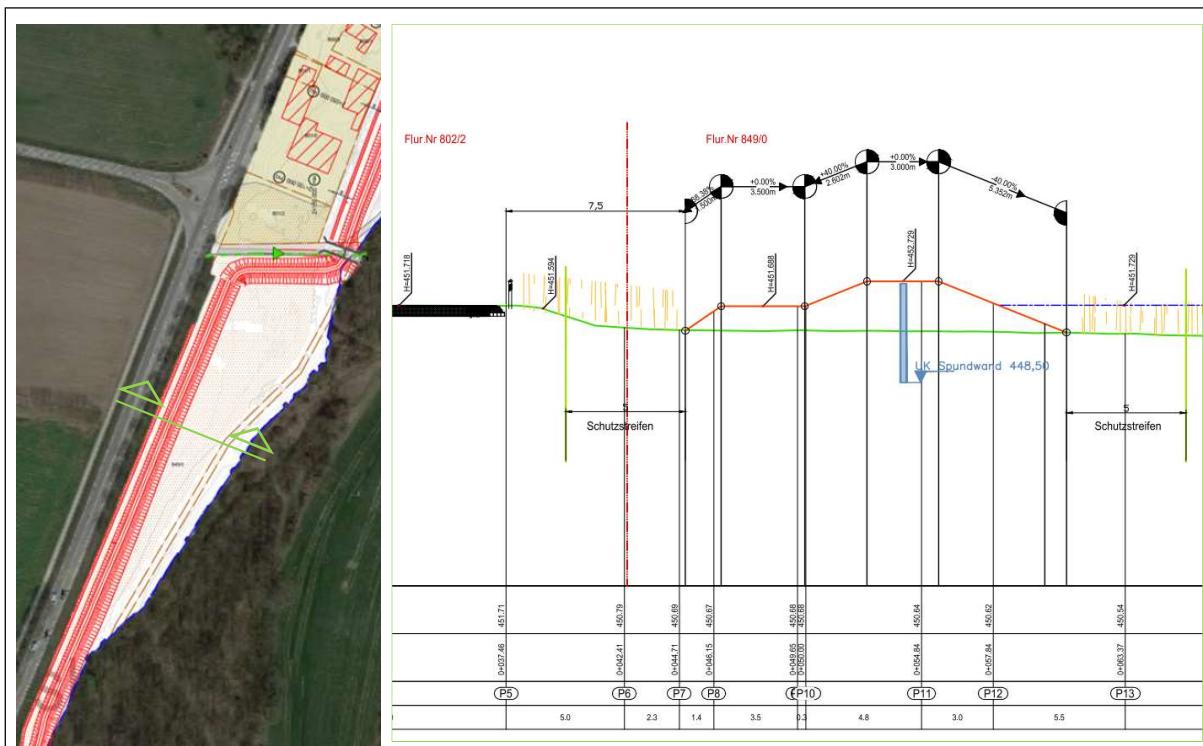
Auszug „Querprofilplan - Deichsanierung BA 14a“
